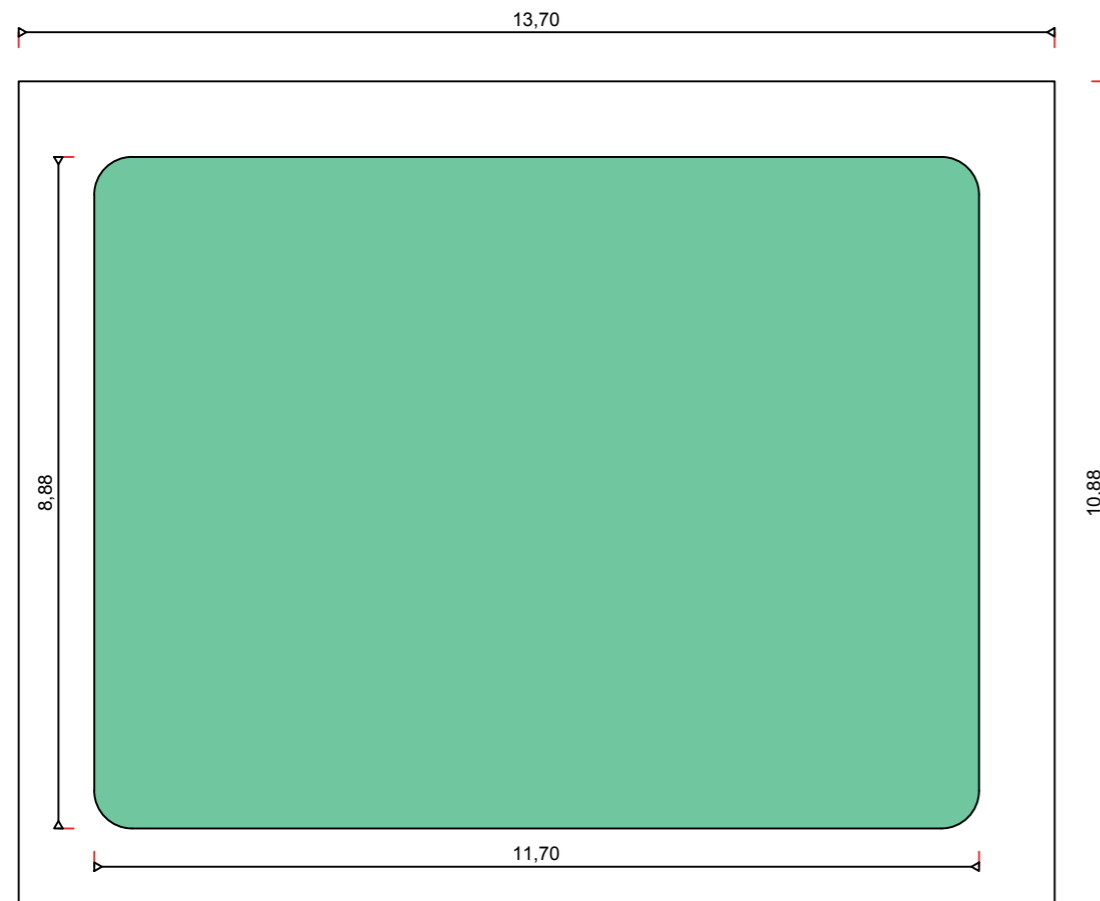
DETAILS - ÉLÉVATIONS DES CAMÉRAS - échelle 1/40e
